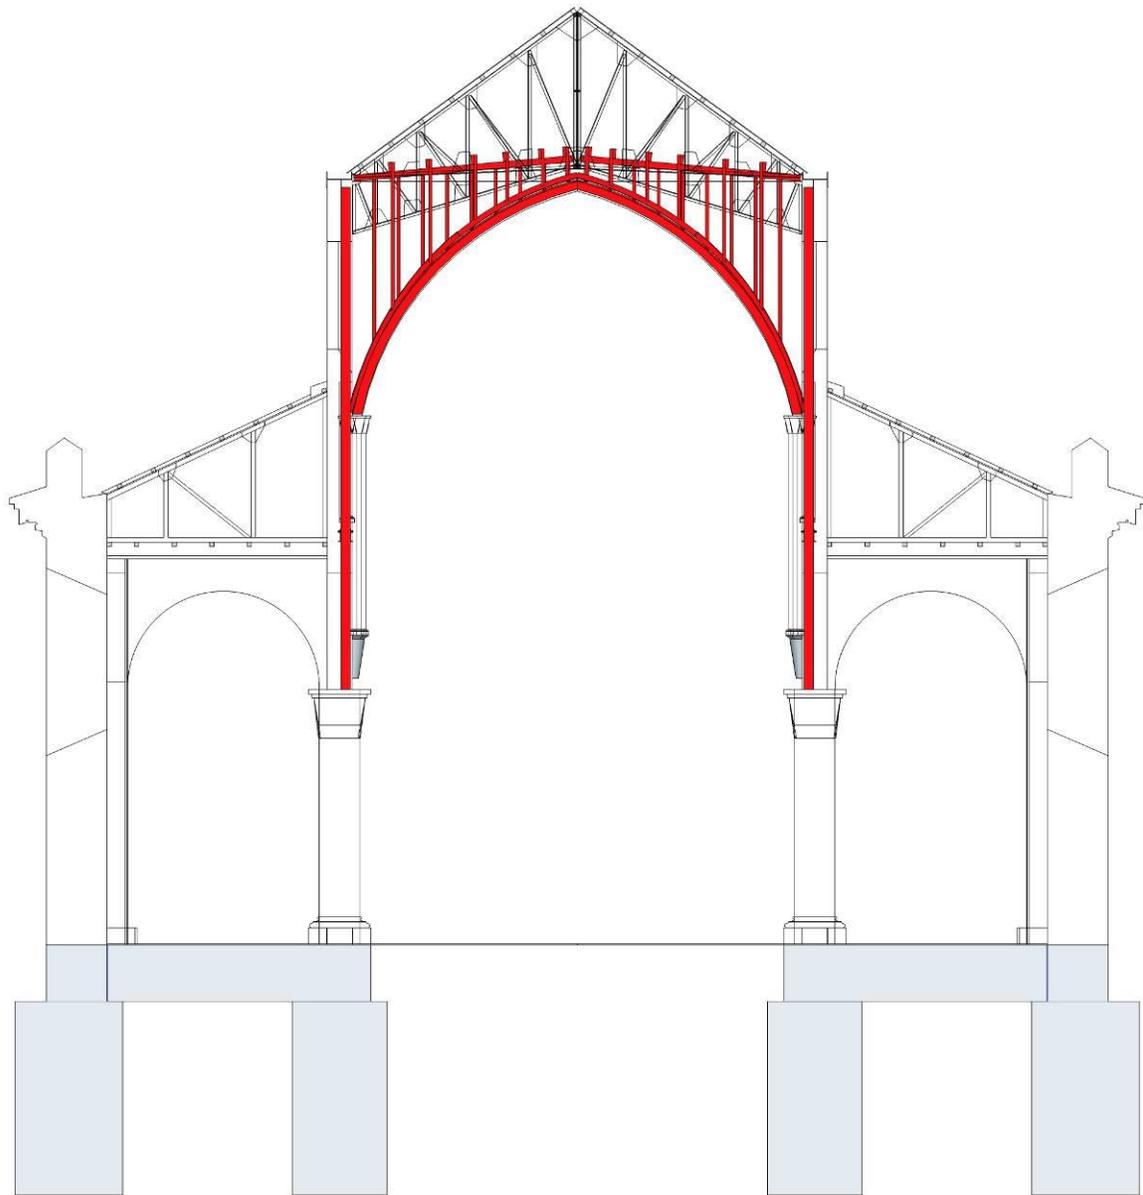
Corte transversal esquemático indicando en rojo estructuras de madera. Elab. propia.
